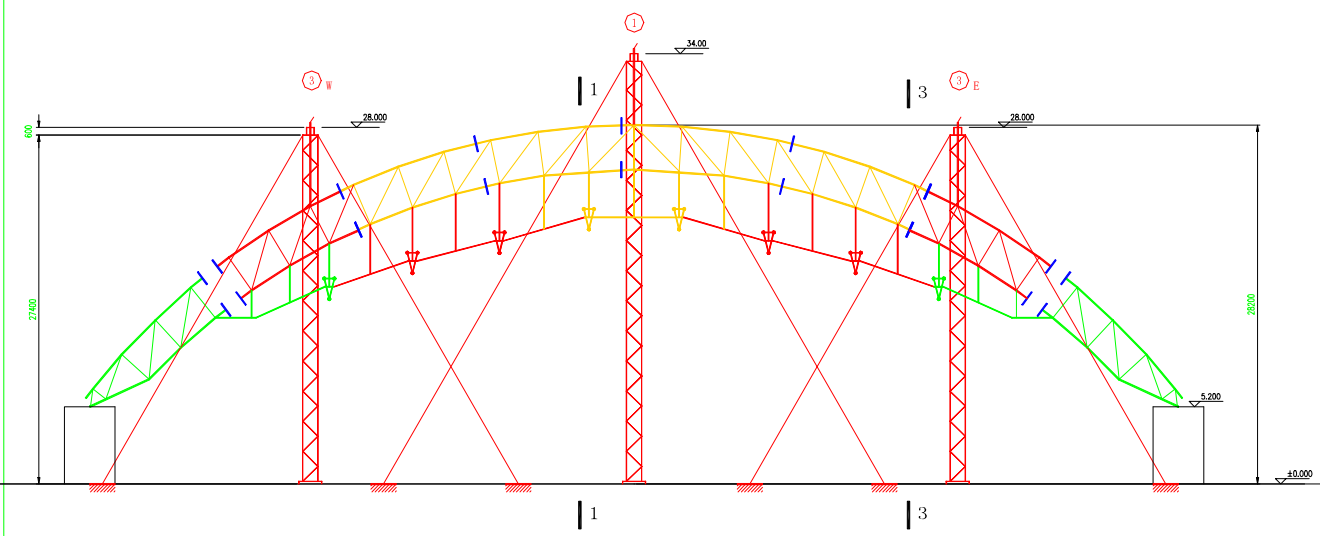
提升千斤顶、桅杆缆风、地锚平面 布置图
